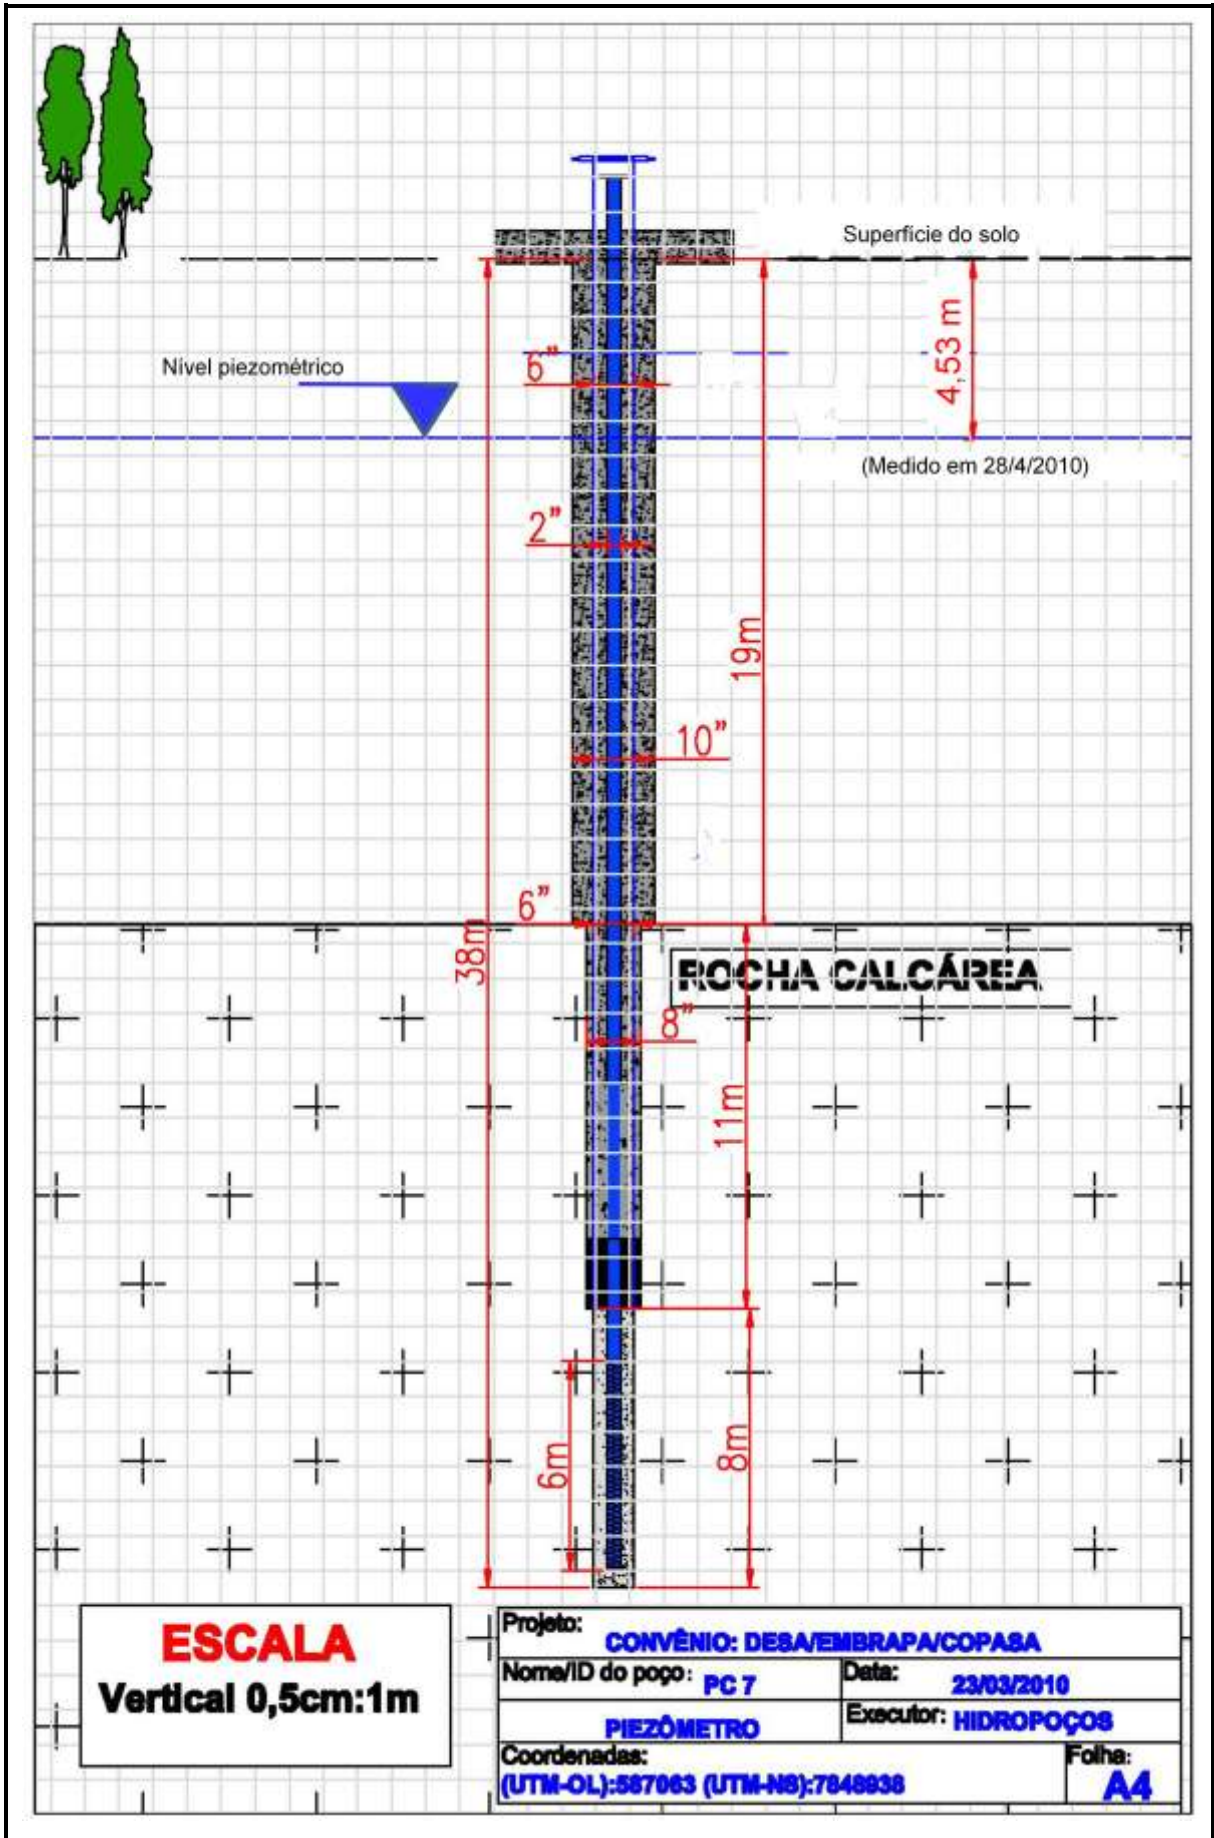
Perfil Construtivo do Poço de Monitoramento PC-7 (Piezômetro)
